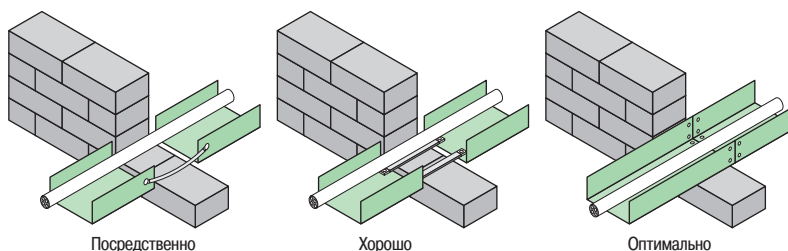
Рекомендации для соединения частей металлического кабелепровода при прохождении через стену
